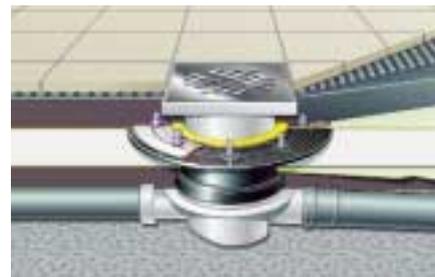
Bodenaufbau bei Bodenablauf mit Preßdichtungsflansch
